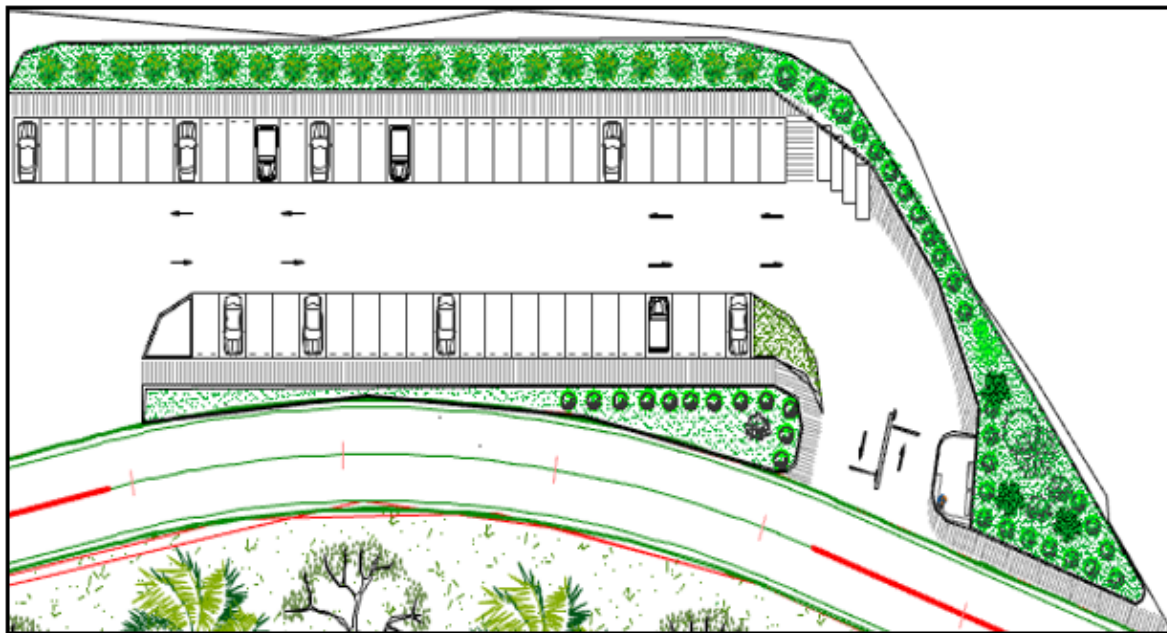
Diseño del sector de aparcamiento (Anexo Plano N°3).
